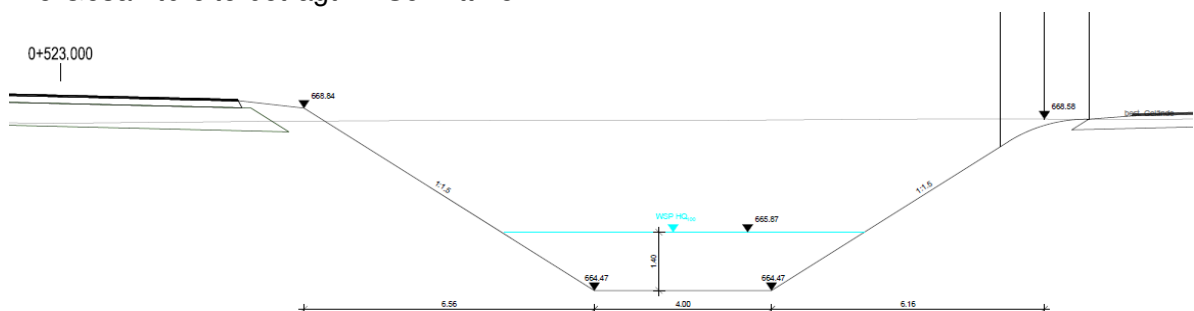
Querschnitt der geplanten Mulde im stark eingetieften ersten Trassenabschnitt mit Trapezprofil bei Bau-km 0+523
